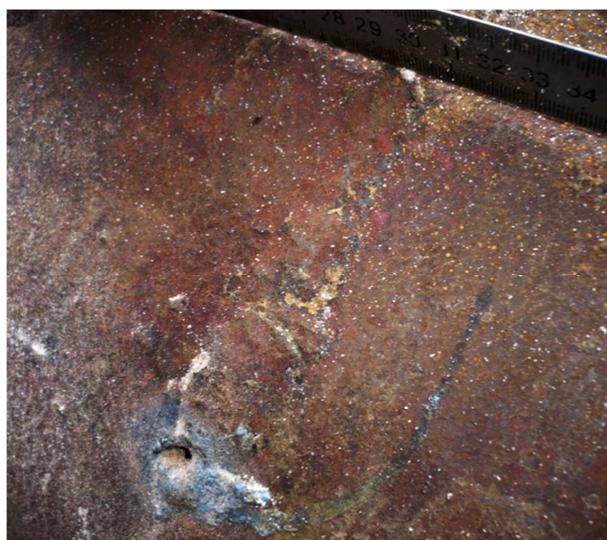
Коррозионная язва – свищ на сварном кольцевом шве
